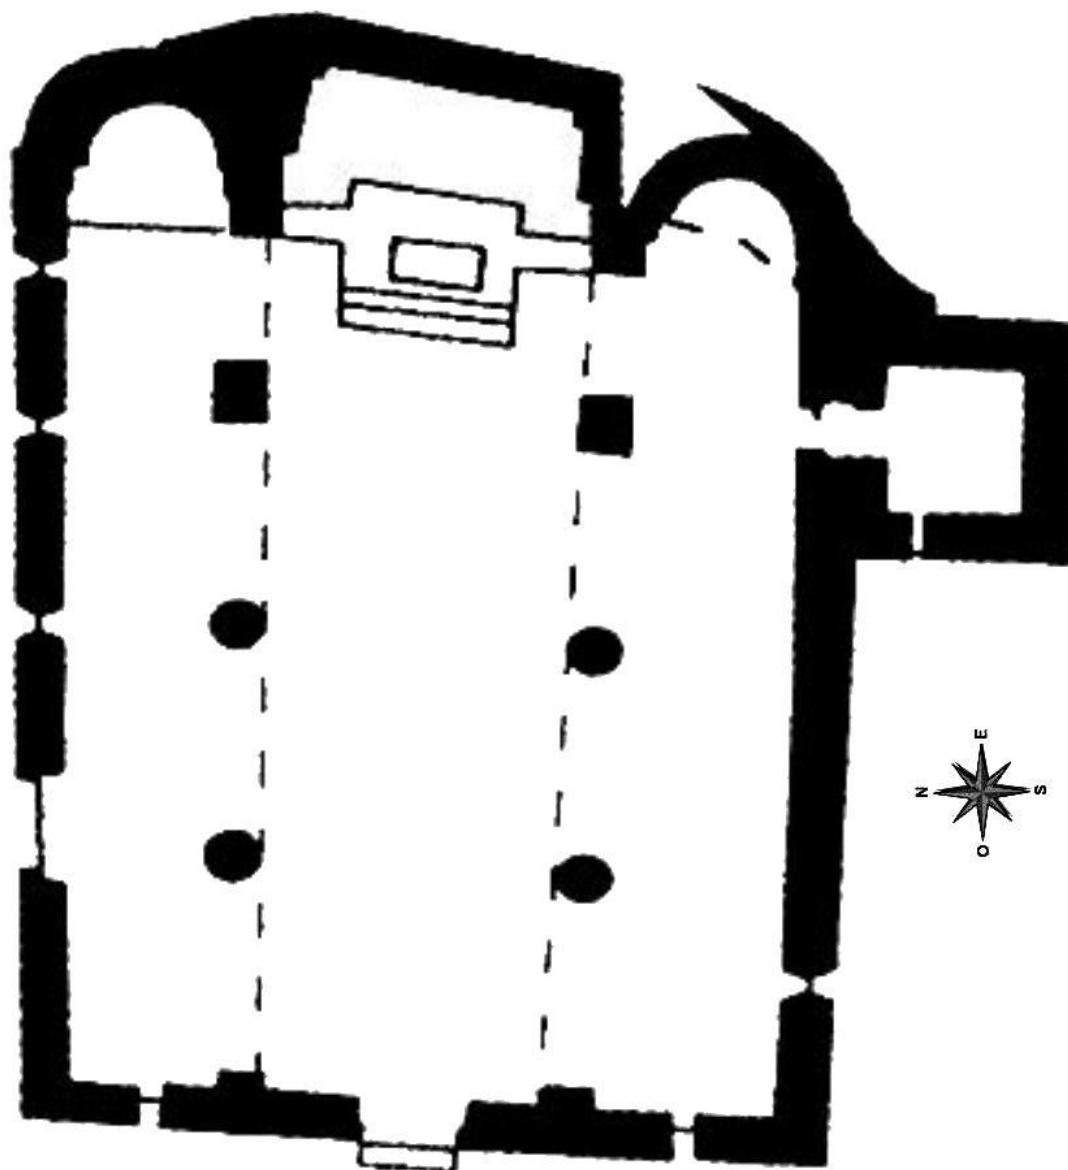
Planta de la iglesia de San Joan de Boi, España
